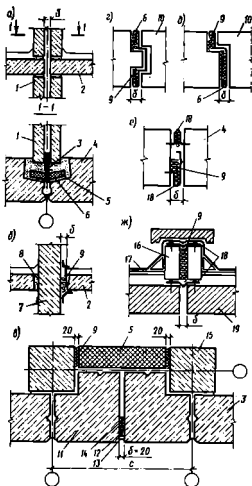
Конструктивные решения деформационных швов во внутренних, в наружных стенах и в покрытиях:
